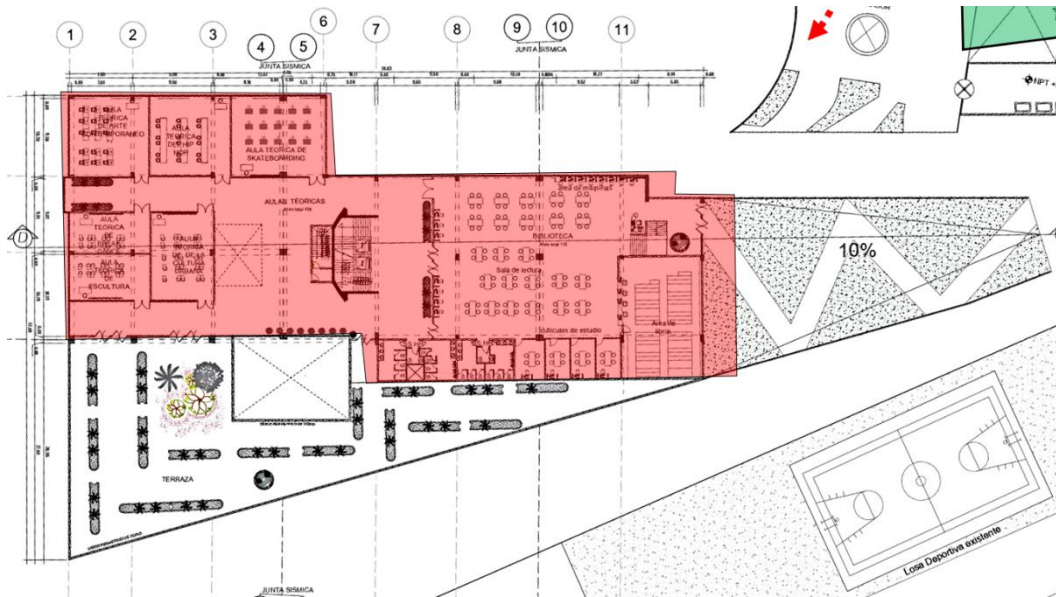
Planta Arquitectónica - Elaboración Propia
